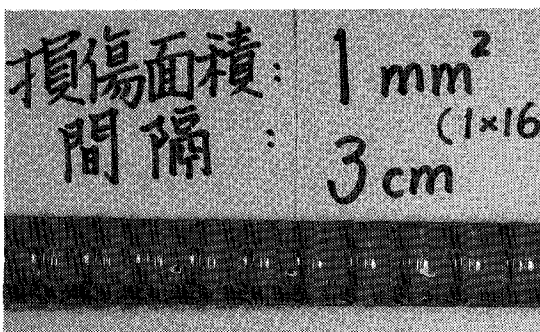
0.2%以下の塗膜損傷 (1 mm² 3 cm 間隔)
